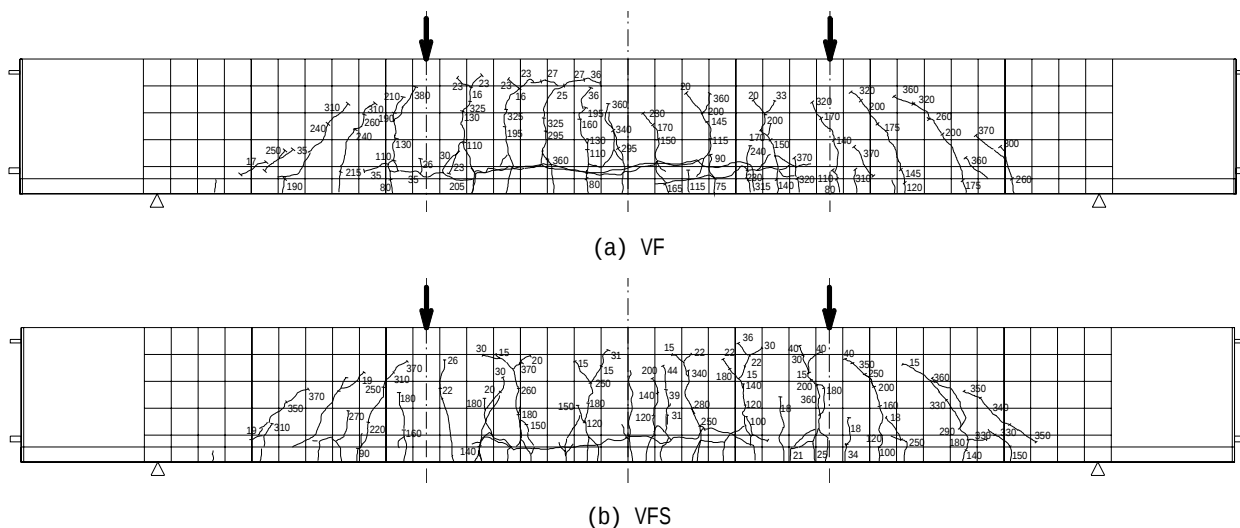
ひび割れ図 - 終局時 (VF, VFS)
